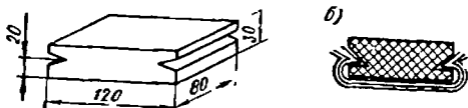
Резиновый шпатель (а) и нанесение шпатлевки (б)
